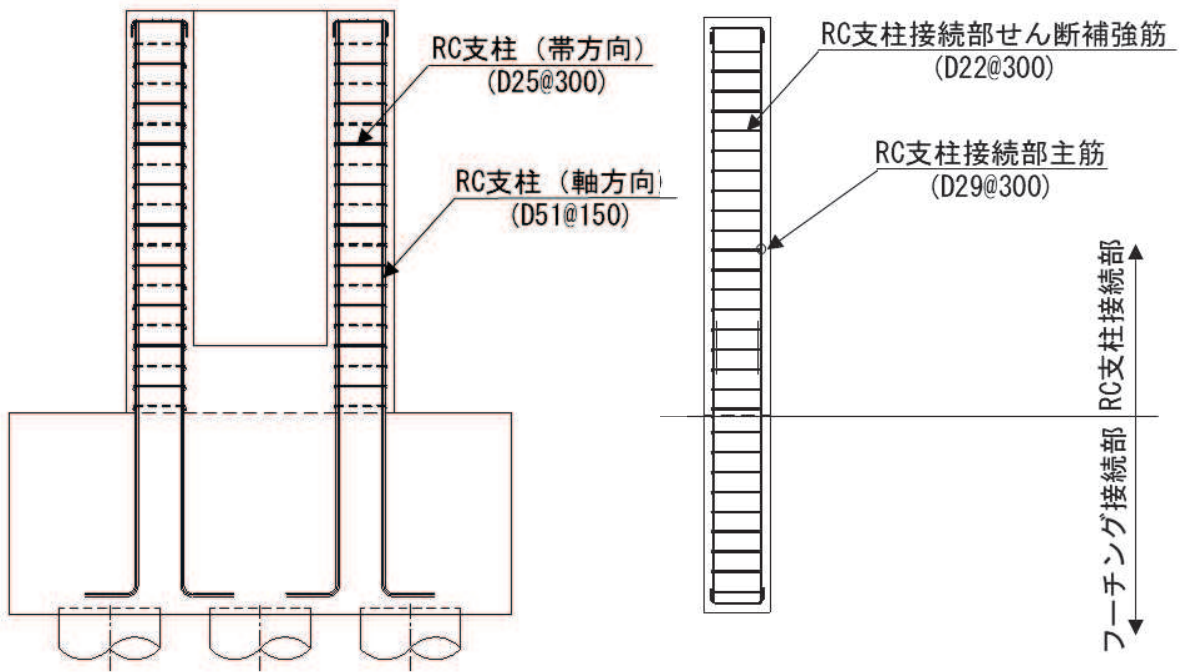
(1) 鋼製遮水壁（鋼桁）の RC 支柱配筋概要図
